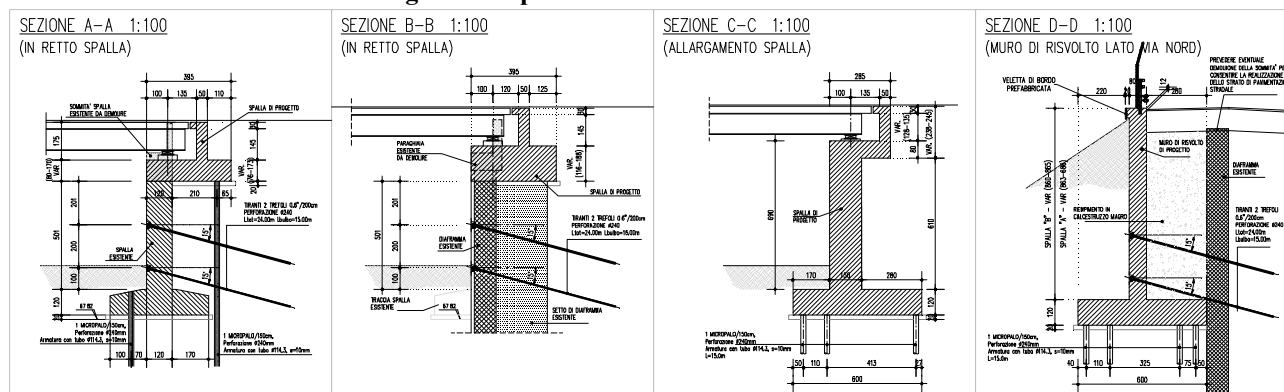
Spalle – Sezione trasversale spalla e muro di risvolto
